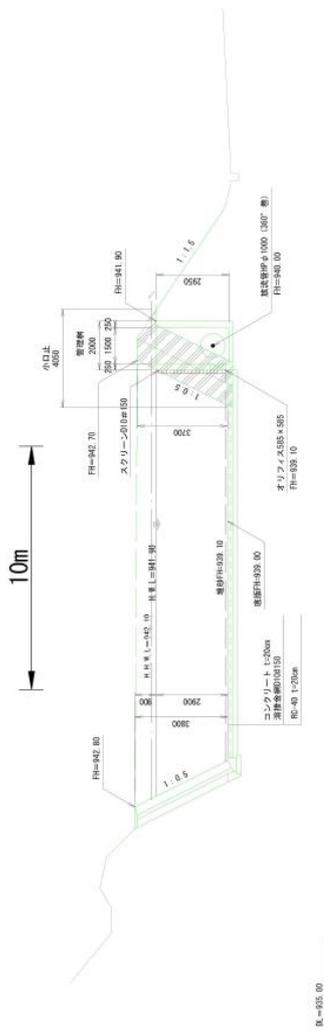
(4) No. 4 調整池計画図 (平面図・断面図)
